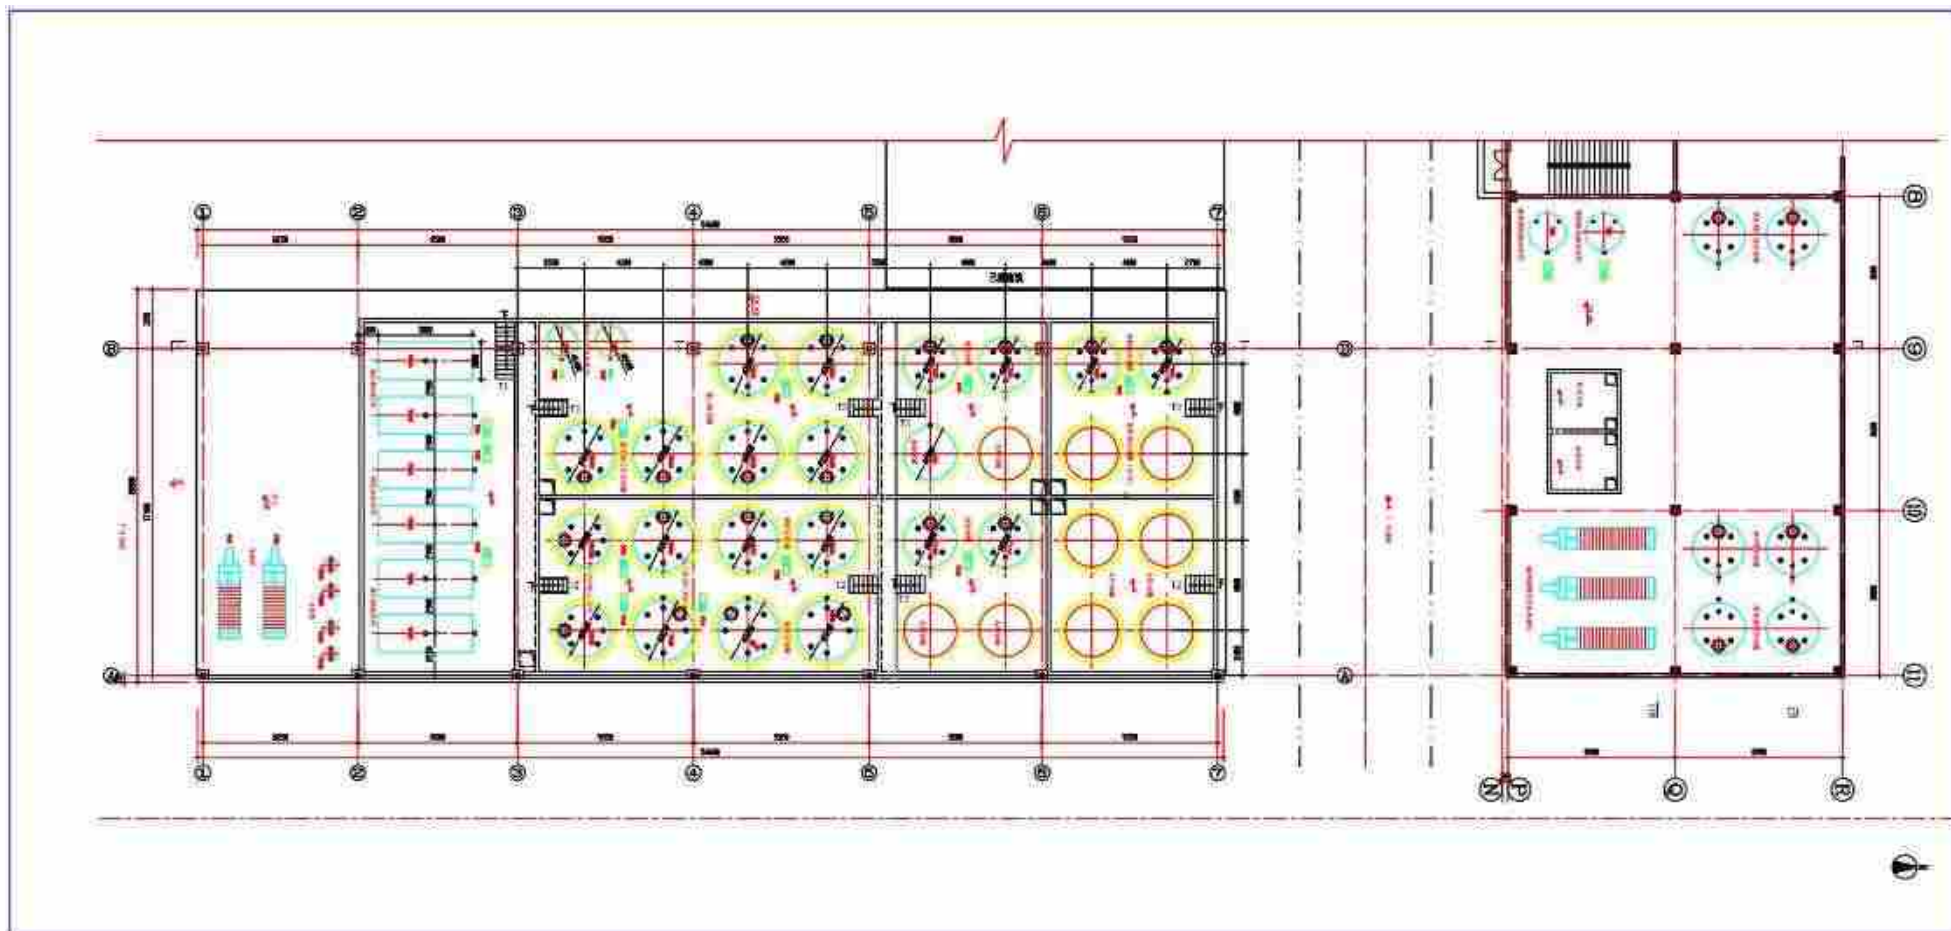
(1) 本次改扩建后 6#厂房 1 层平面布置图
